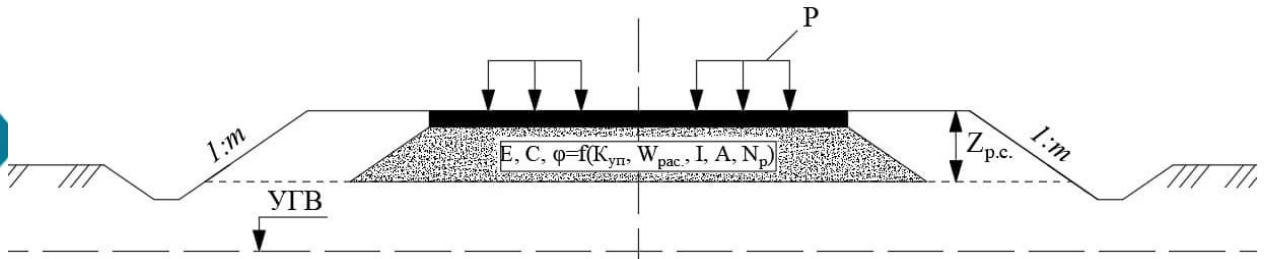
Схема земляного полотна из засоленного грунта в поперечном профиле
